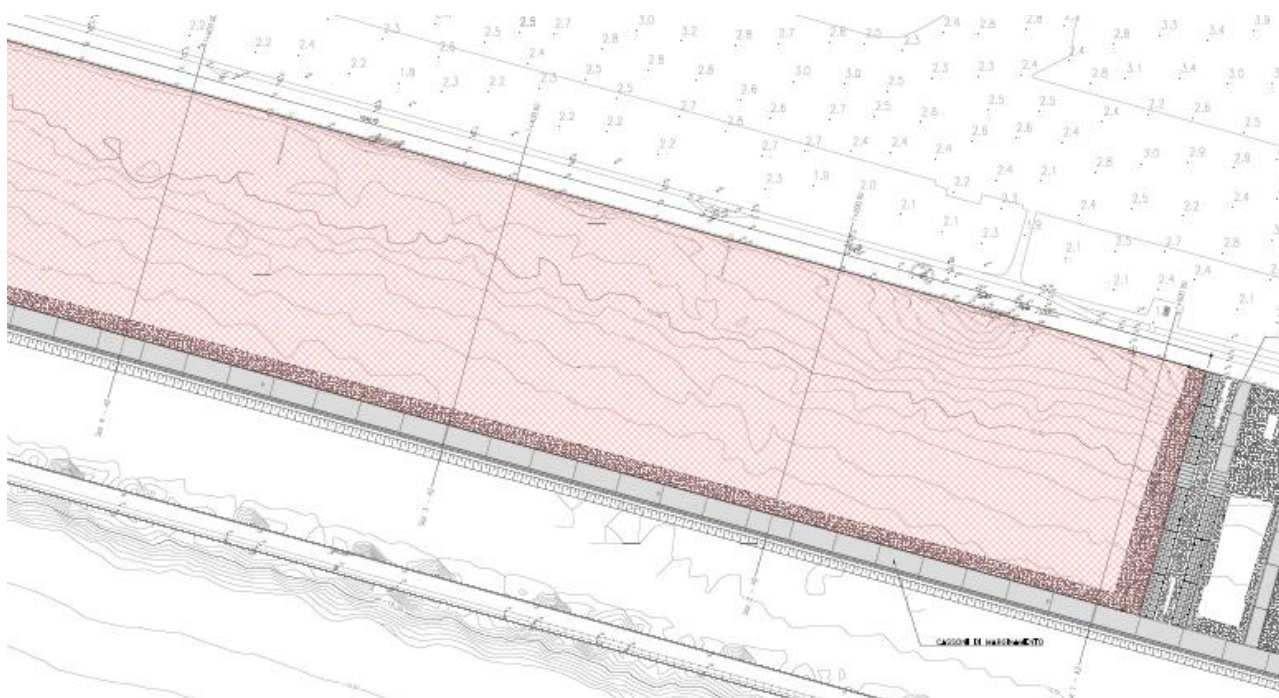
Vasca A2 Stralcio Planimetrico con individuazione dell'area interessata dalla posa in opera della geomembrana HDPE +geotessile tessuto non tessuto
